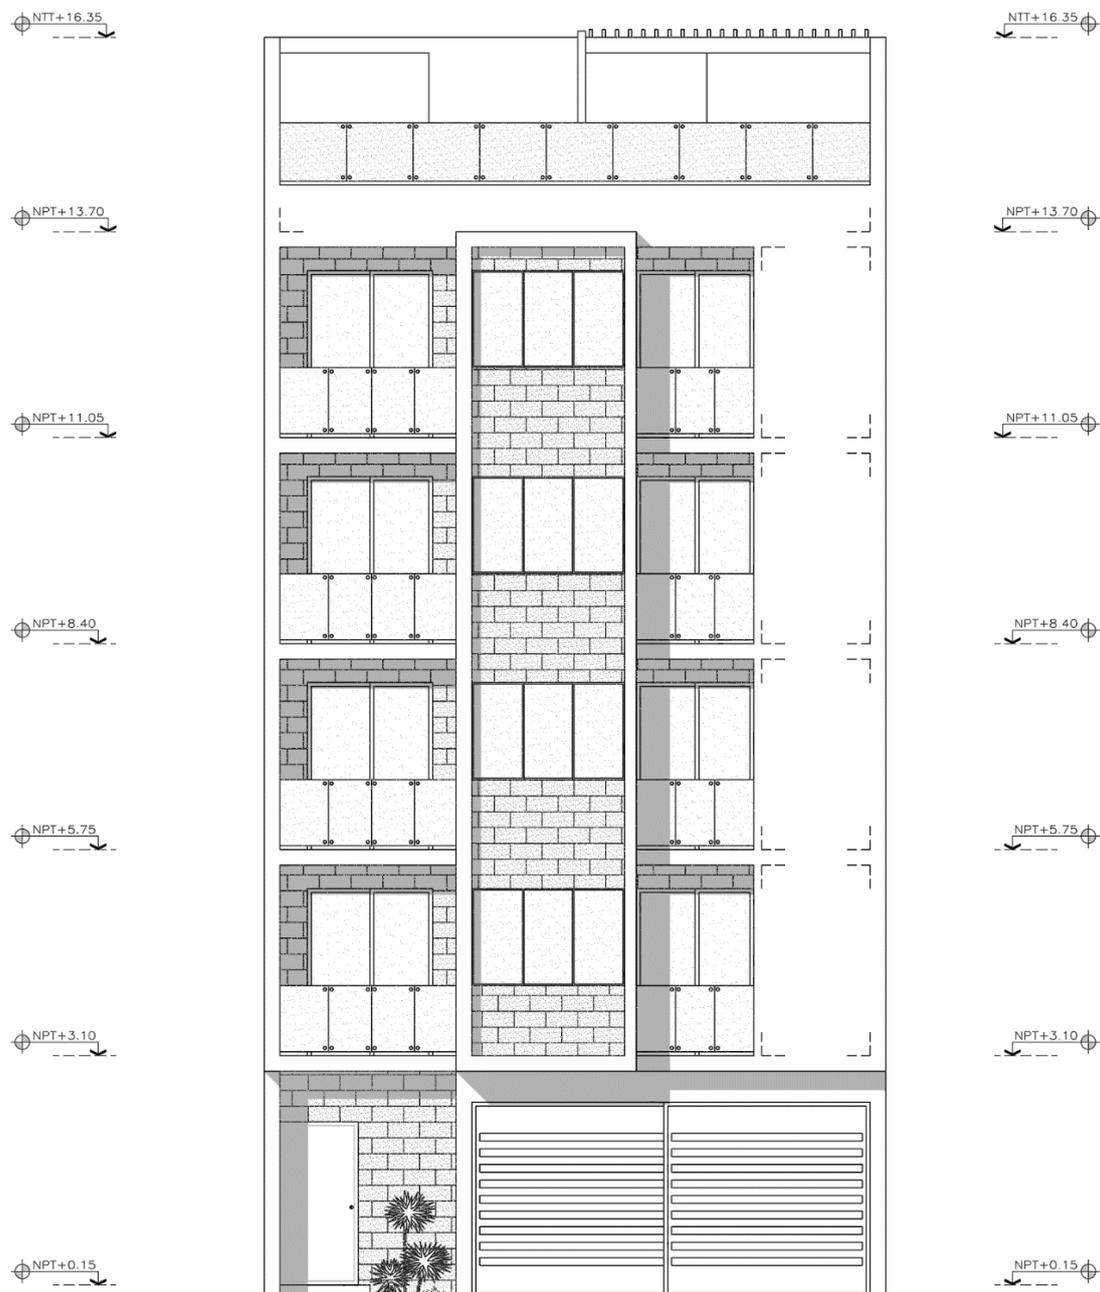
Plano de Elevación - Casa EAVPFuente: Propia*ELEVACIÓN
